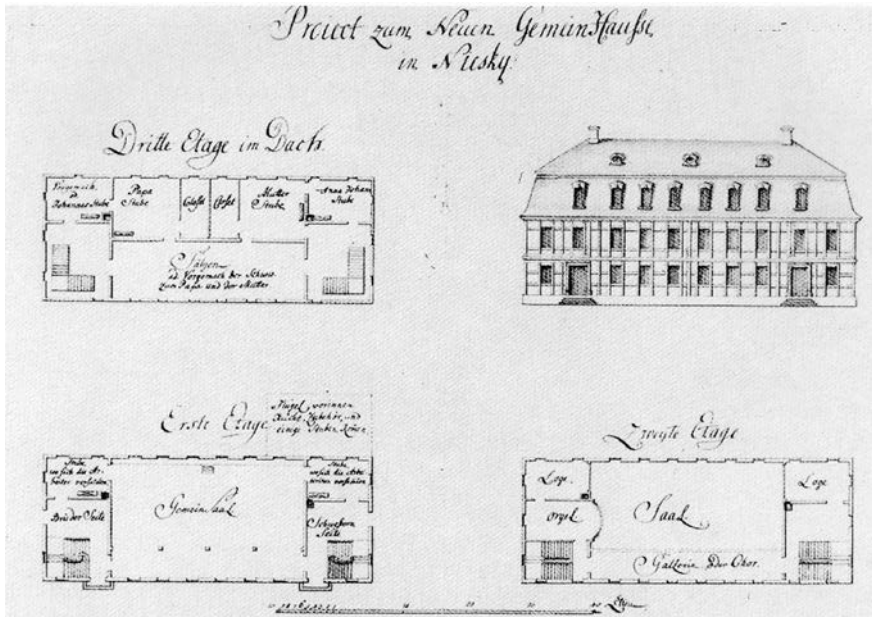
Projekt zum neuen Gemeinshause in Niesky, Entwurf zum Bau eines Gemeinshauses mit Kirchensaal in Niesky, Grundriss Erdgeschoss, erste und zweite Etage, Ansicht der Fassade, nicht ausgeführt, [1756], (UA, TS Bd. 3.8)
